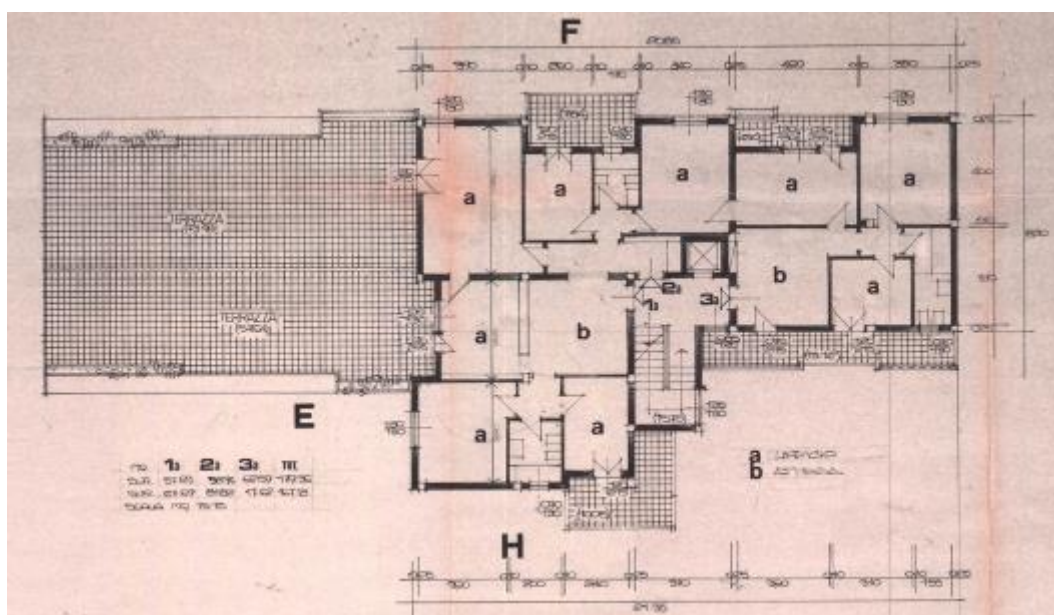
Progetto 1984 – Piano terra e Piano primo
